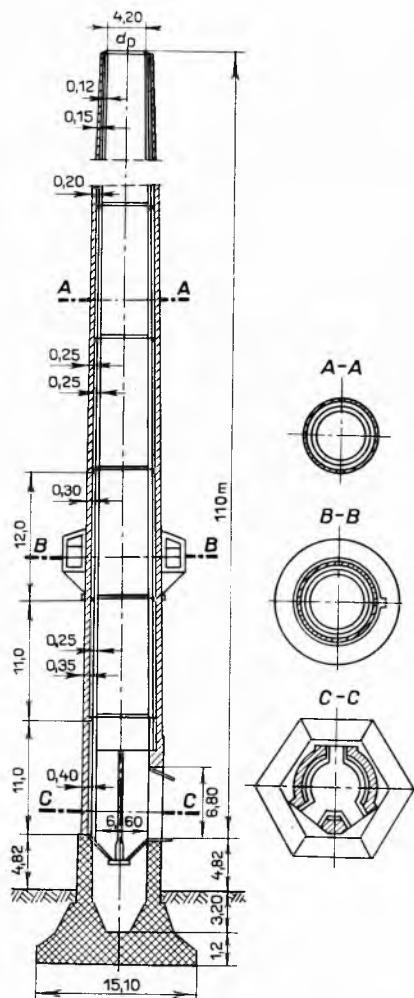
Armiranobetonski tvornički dimnjak od prefabriciranih betonskih blokova. *a* Vertikalni presjek, *b* vertikalni i horizontalni presjek betonskih blokova, *c* horizontalni presjek
